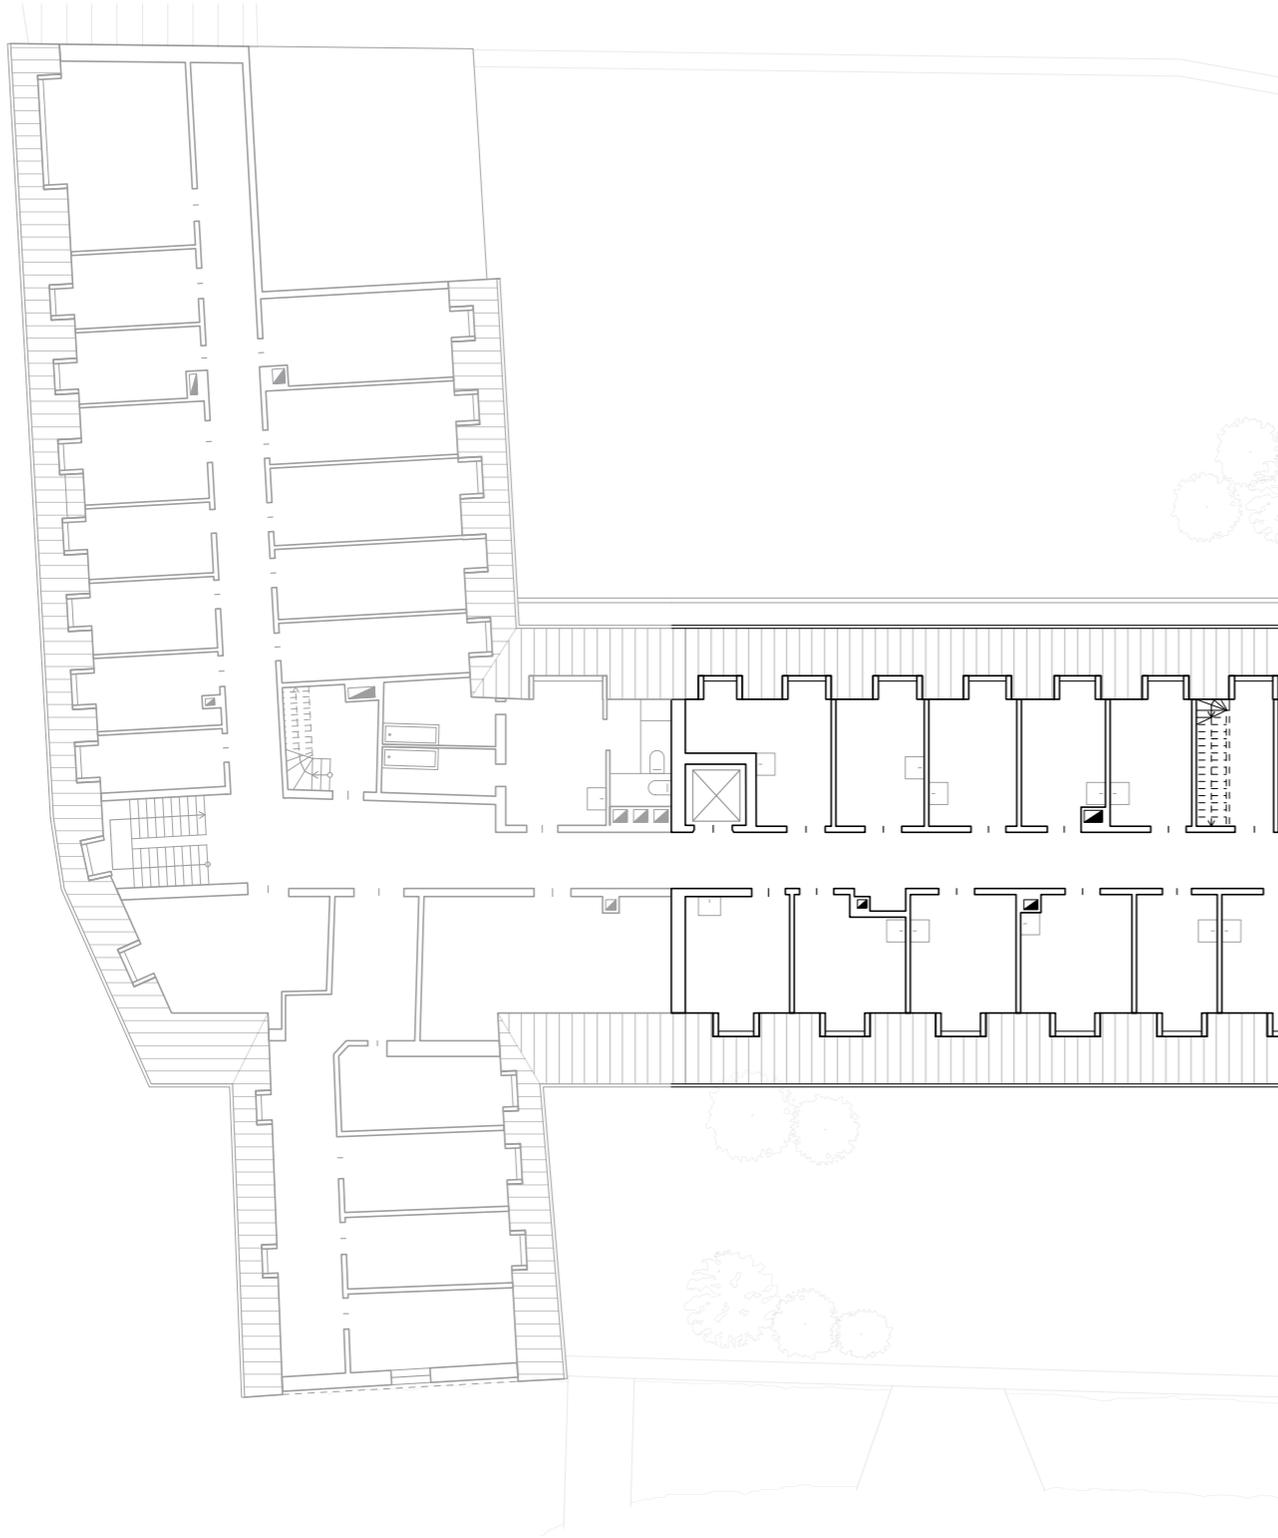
Kloster St. Ursula - Grundriss Dachgeschoss
